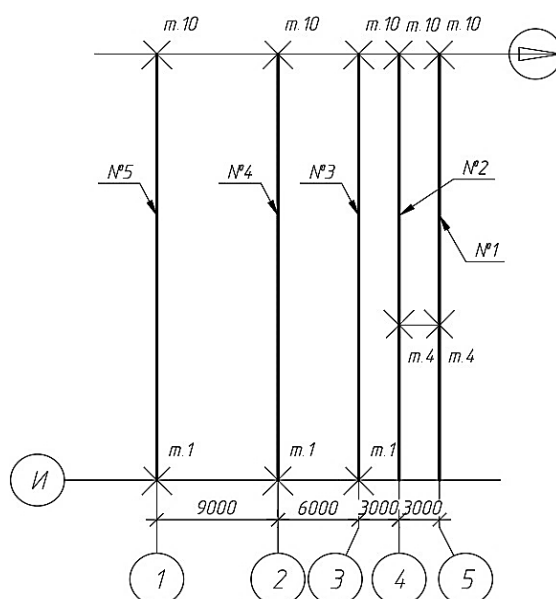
Схема розташування аркових конструкцій блоку Г і Д
